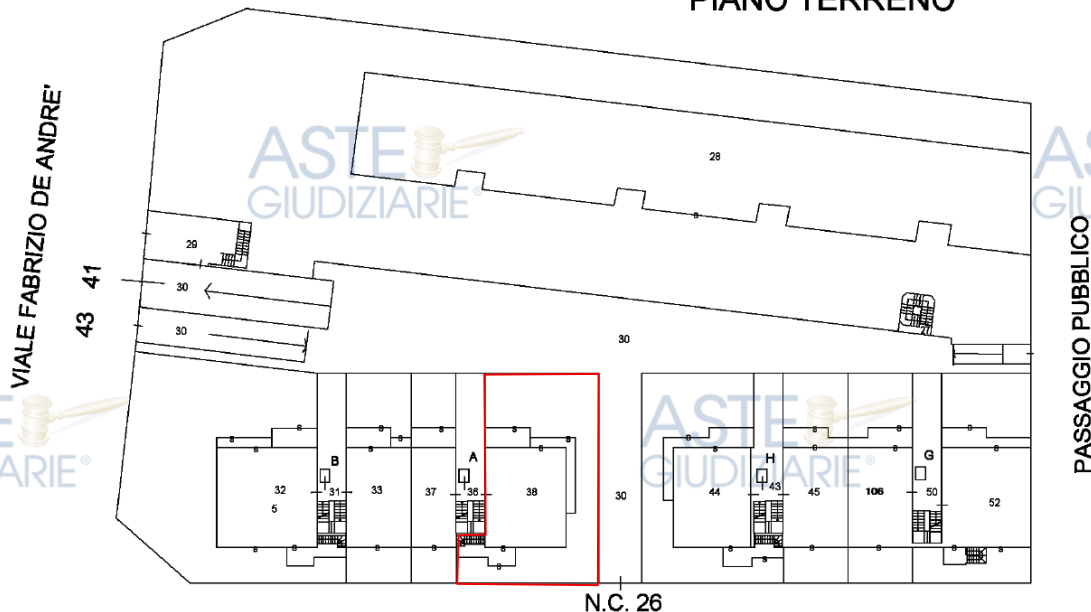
Planimetria dell'elaborato planimetrico – Piano Terreno
